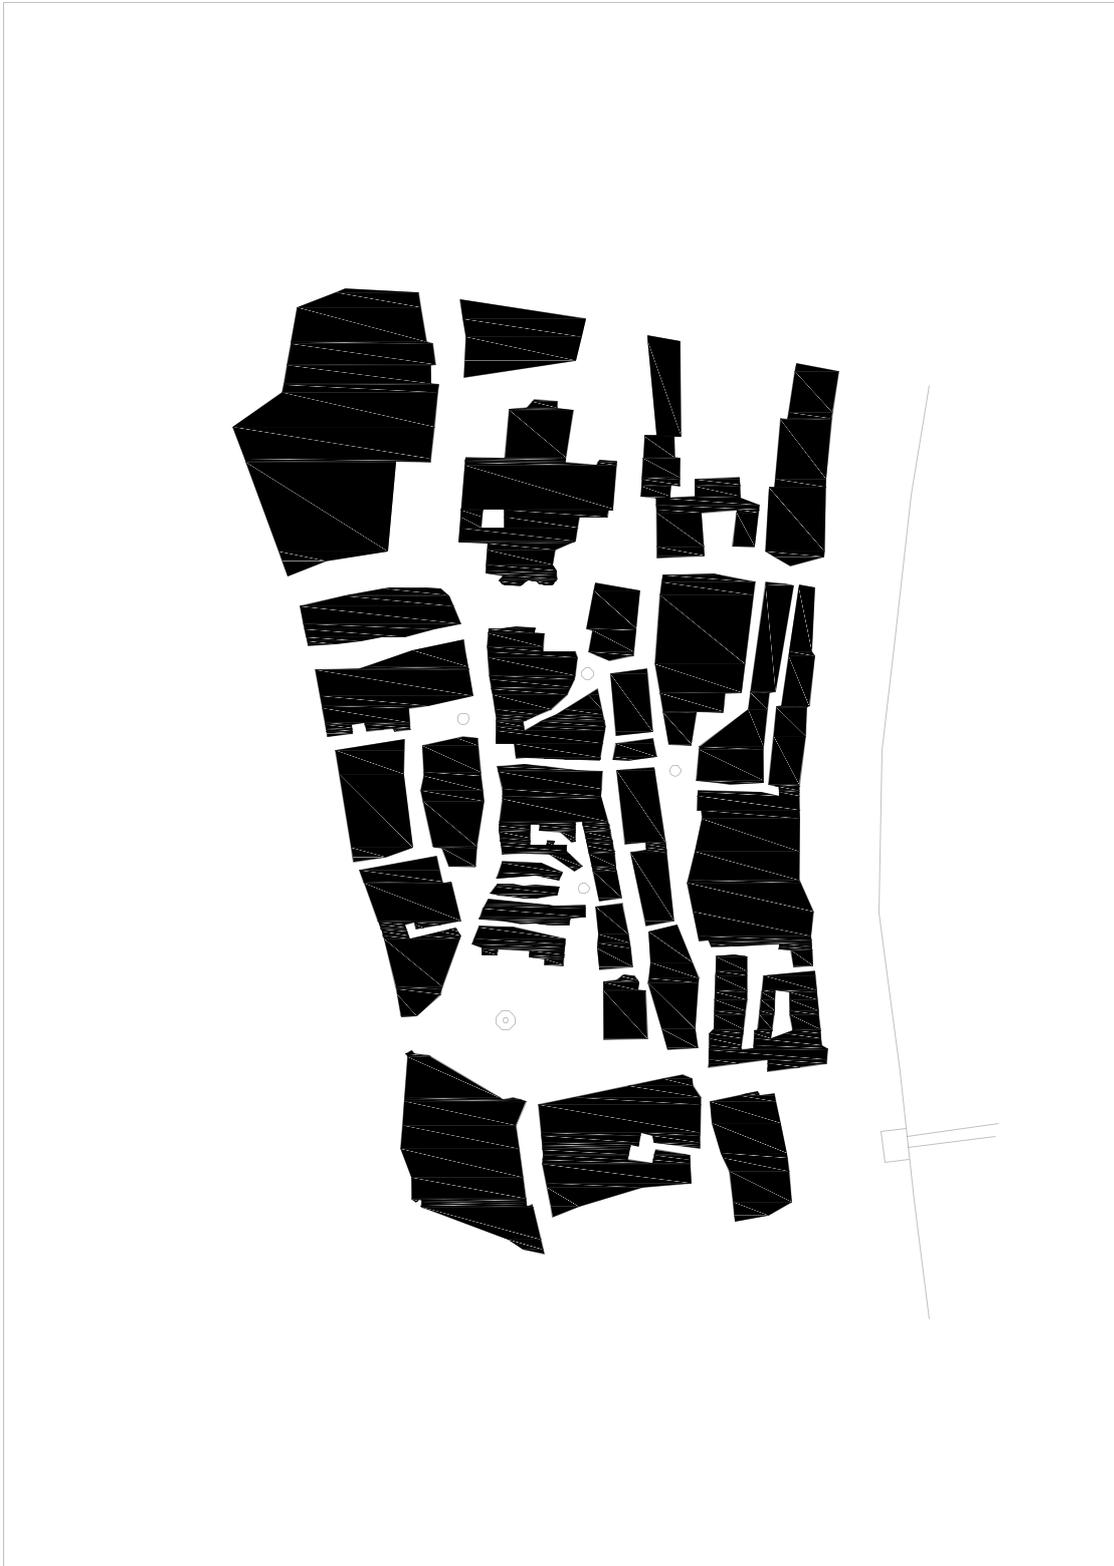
Planta de Frankfurt-Römerberg, estado anterior al proyecto.
